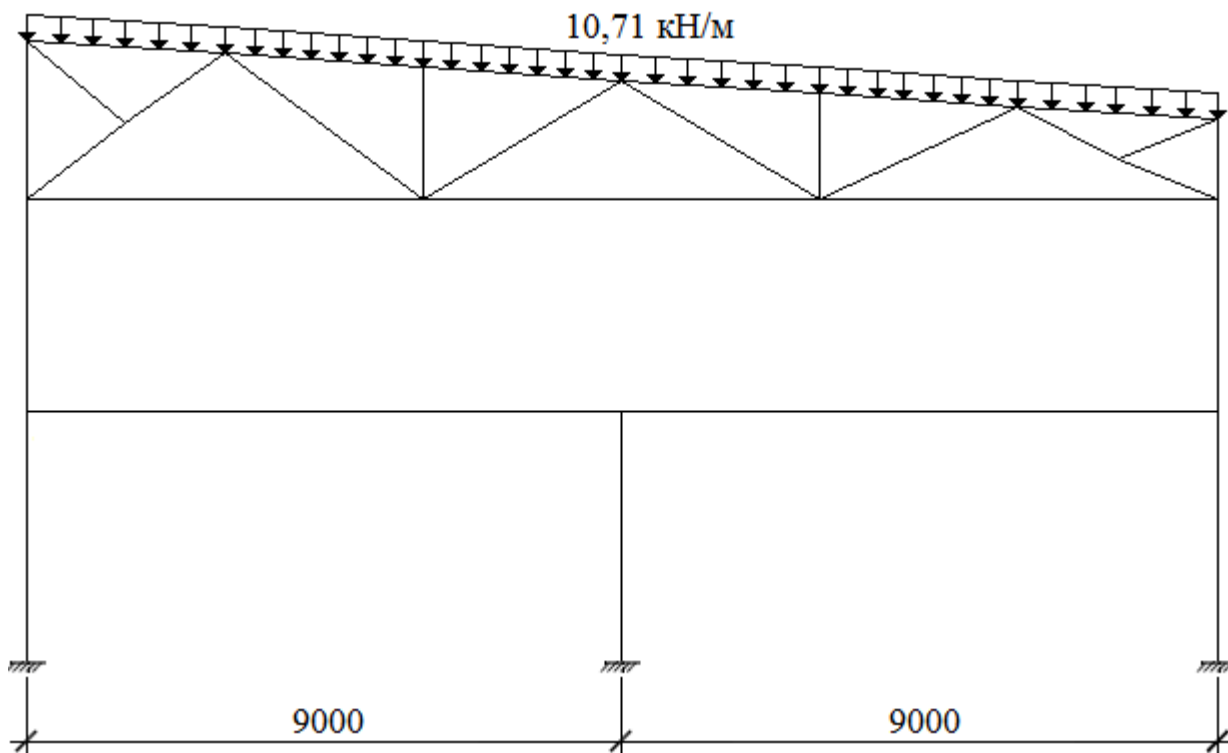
Снеговая нагрузка на раму на весь пролет
